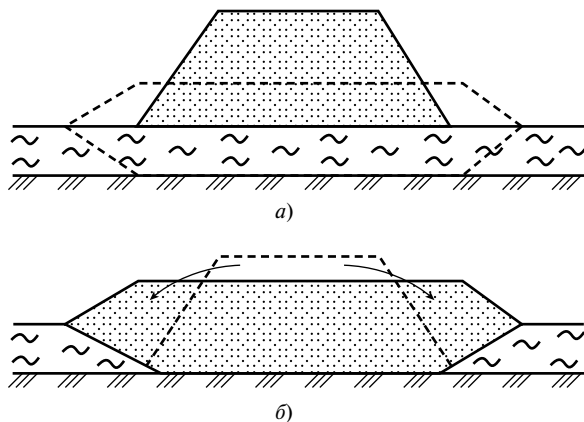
Схема посадки насыпи на дно болота по методу перегрузки: *а* — первоначальный поперечный профиль насыпи; *б* — поперечный профиль насыпи после осадки и доработки ее до проектной отметки
